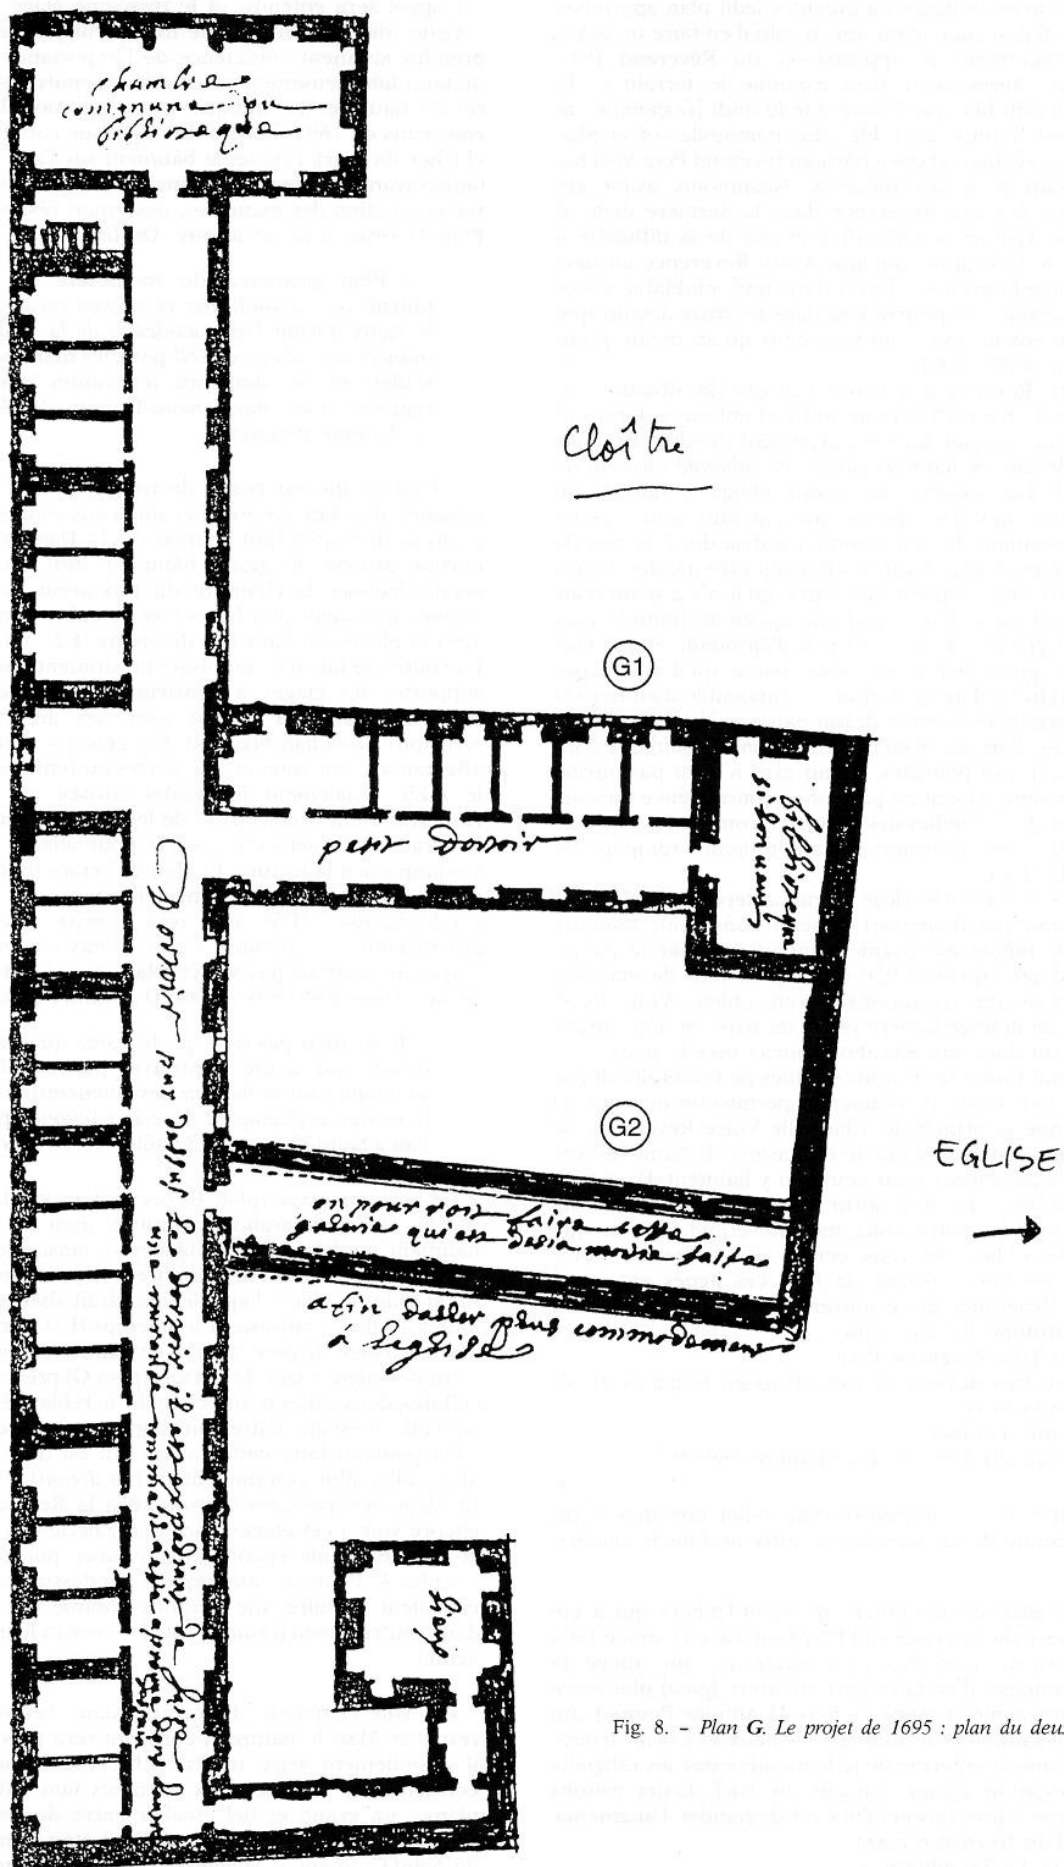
Plan G. Le projet de 1695 : plan du deuxième étage.
